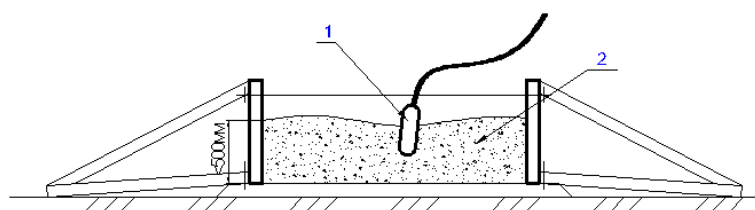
Схема вибрирования бетонной смеси глубинным вибратором;
